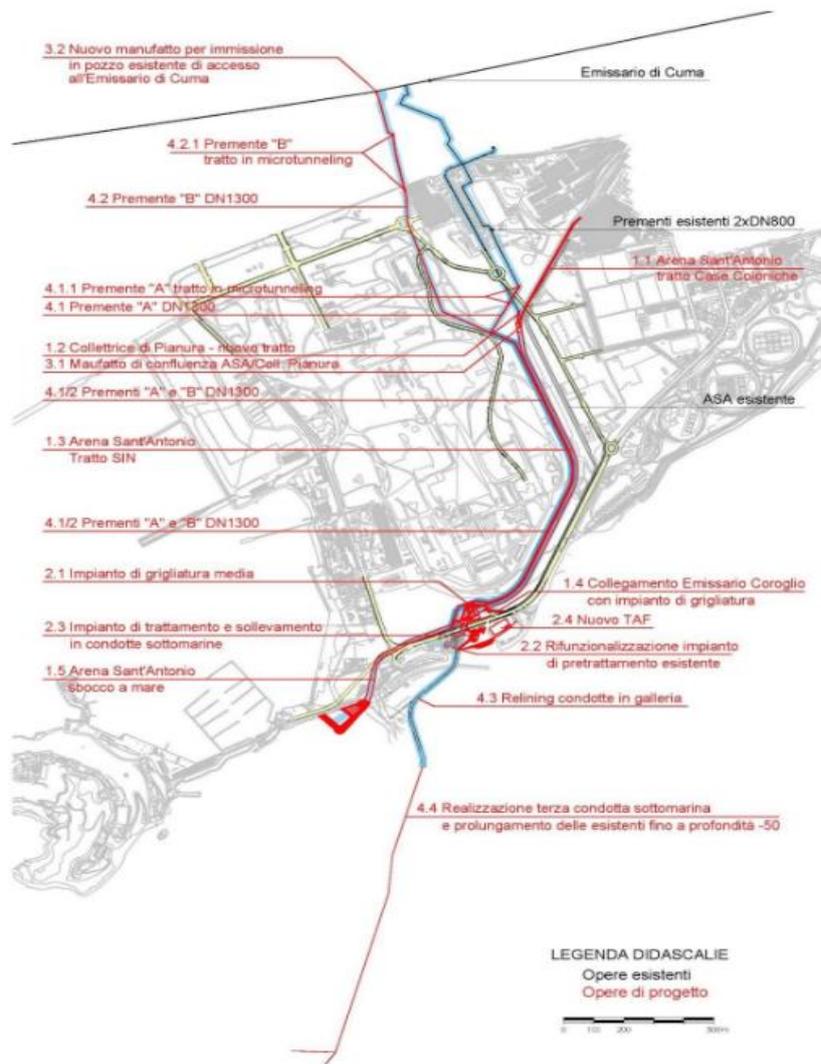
Planimetria schematica delle opera idrauliche di progetto
